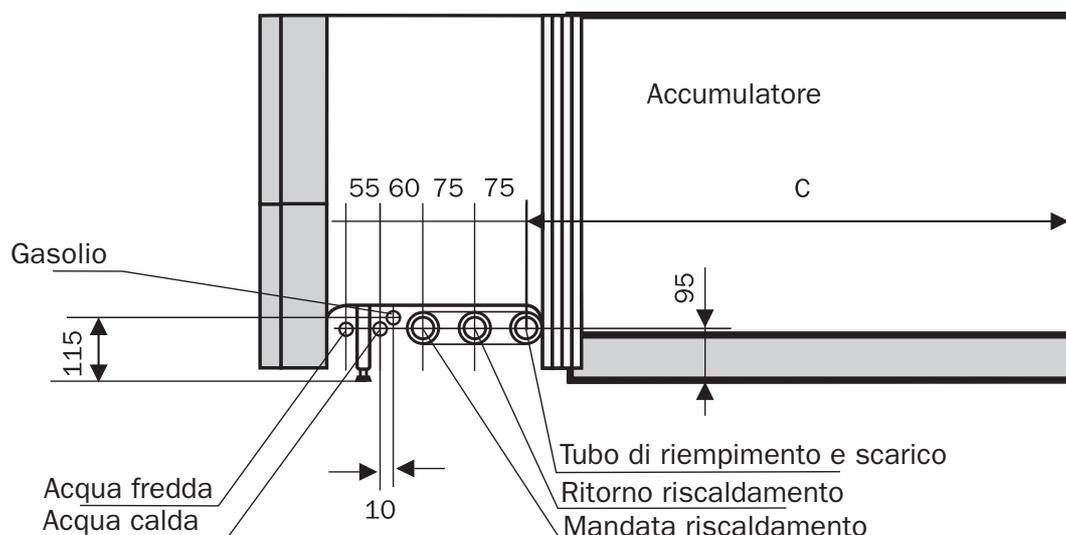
Prospetto degli allacciamenti, condotti dalla cappa di copertura lateralmente verso destra
